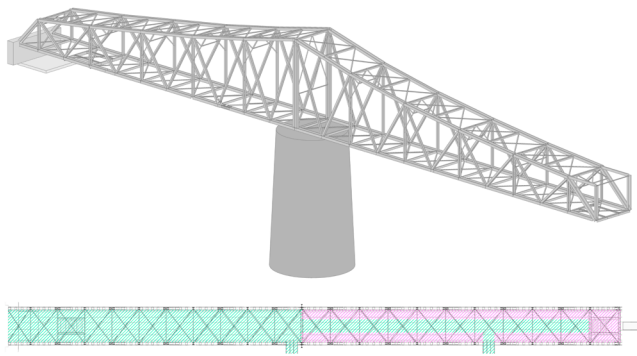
Modelo 3D y planta marcando la zona de acceso al público en color verde y en rosa donde no se dispondrá pavimento
